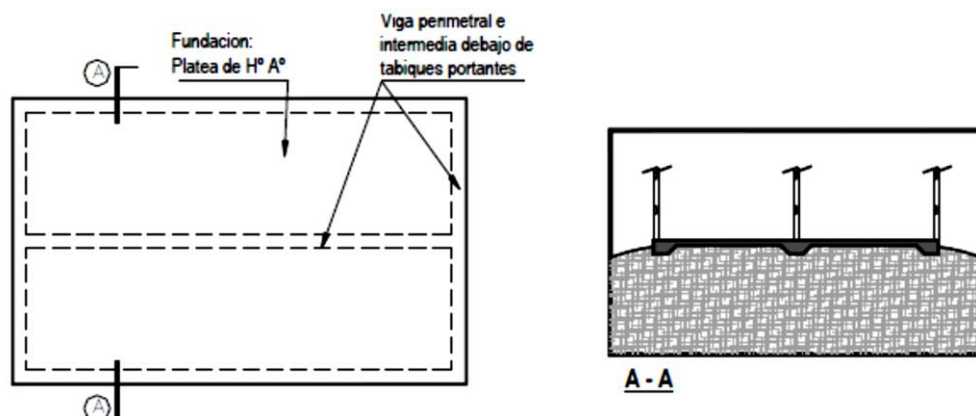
Planta y sección de platea. (ConsulSteel, 2002).
